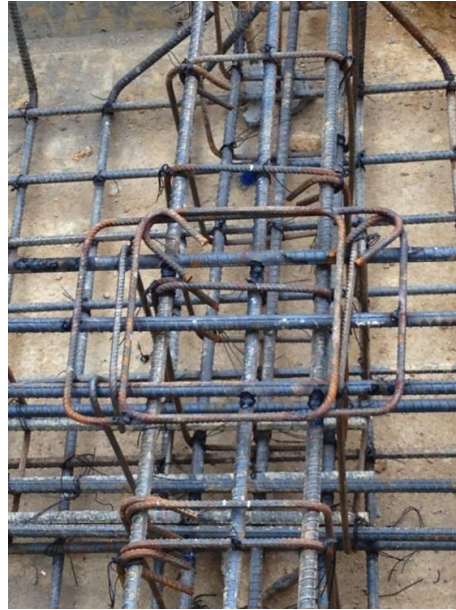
Alineación y fijación del estribo tipo de la columna mediante soldadura.
